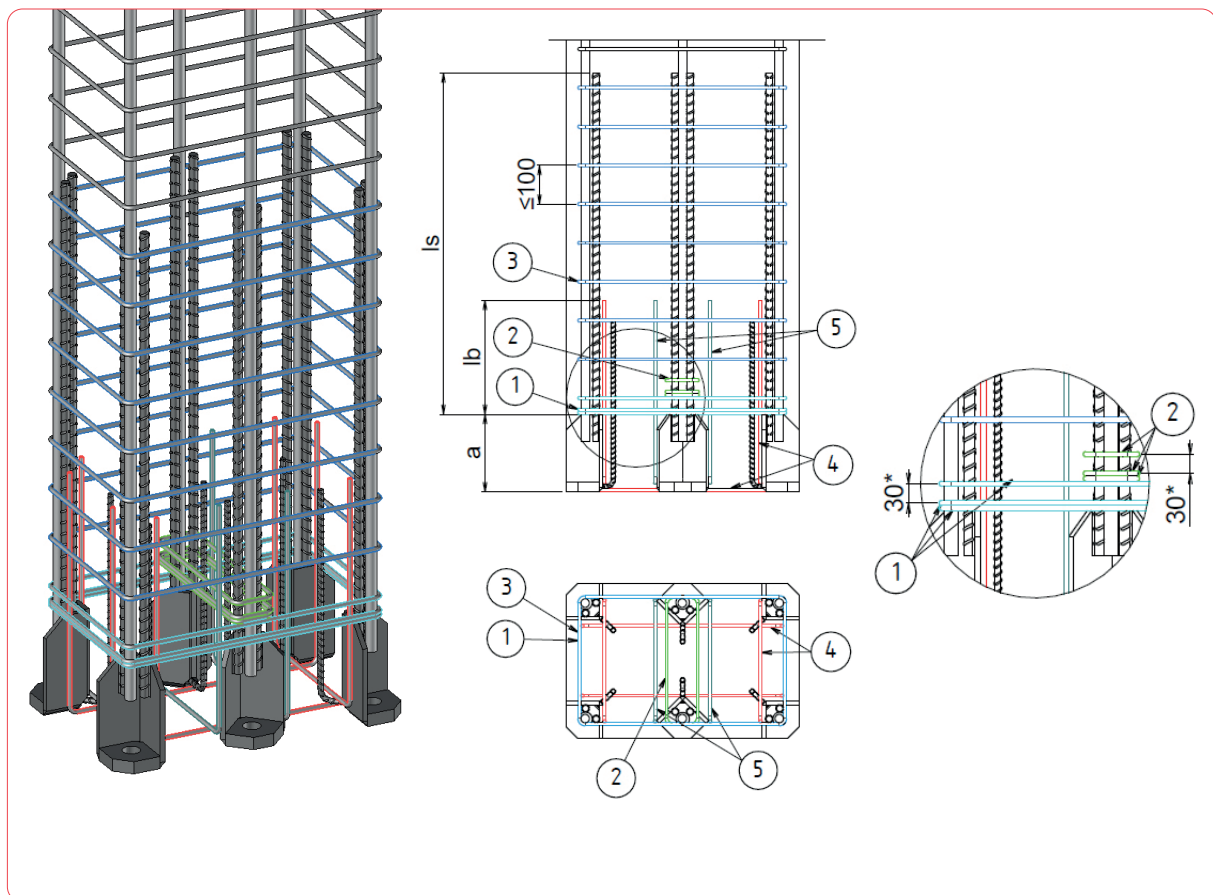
Detalles de armaduras mínimas en conexión con pies de pilar
